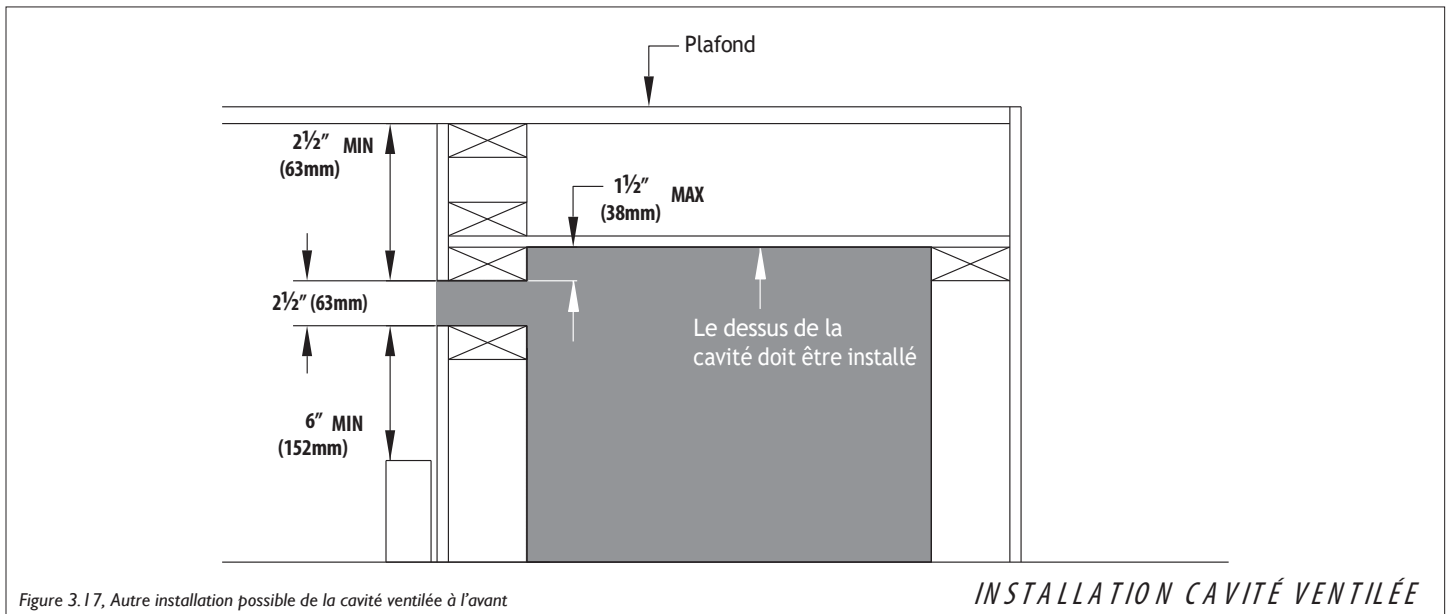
, Autre installation possible de la cavité ventilée à l'avant
